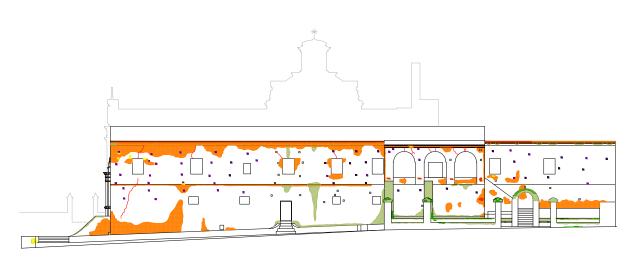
Relevamiento de lesiones - Fachada Norte
